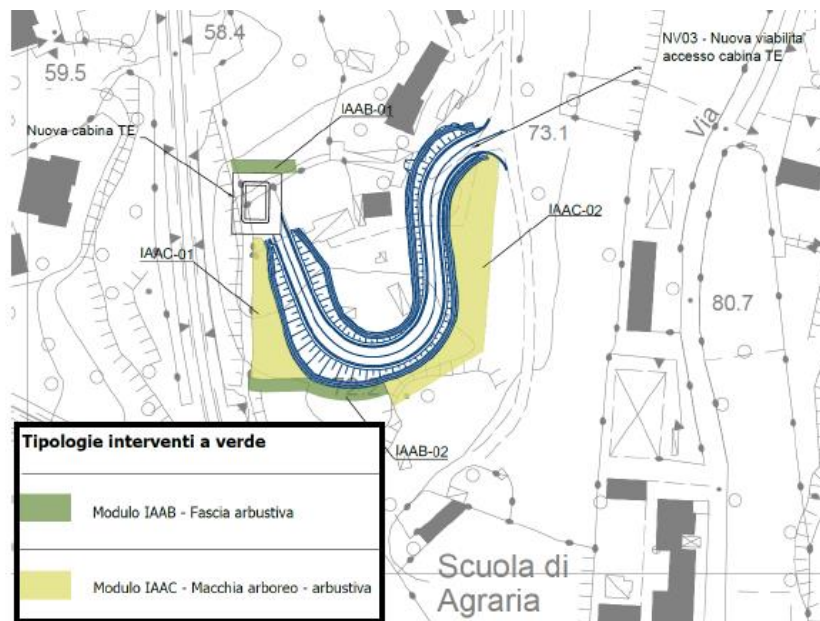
Stralcio Planimetria degli interventi di mitigazione
